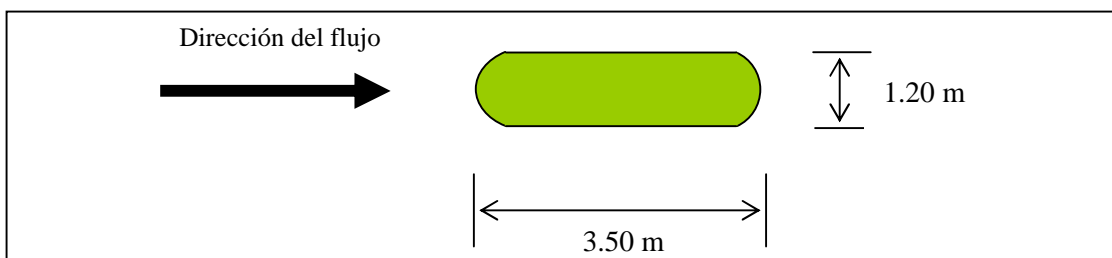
Sección del pilar del Puente Rica Playa, carretera Tumbes – Rica Playa
